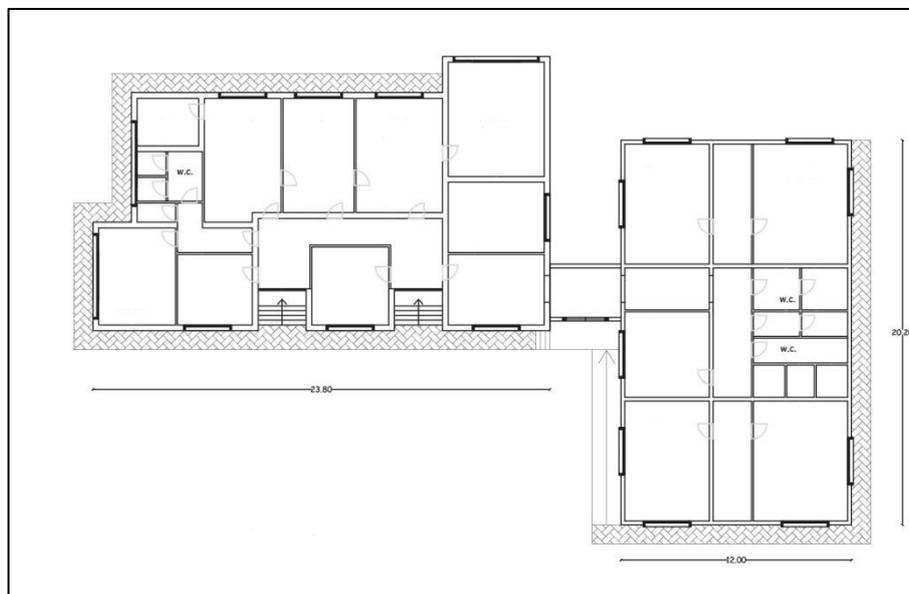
Planimetria dello stato di fatto dell'edificio in uso all'Agenzia delle Dogane-Monopoli
